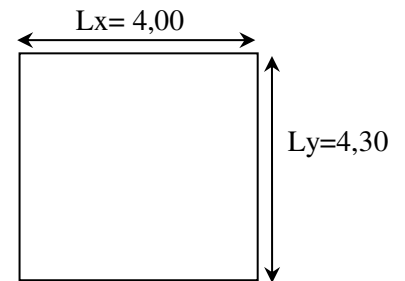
Dimensions d'un panneau de la dalle le plus défavorable.
